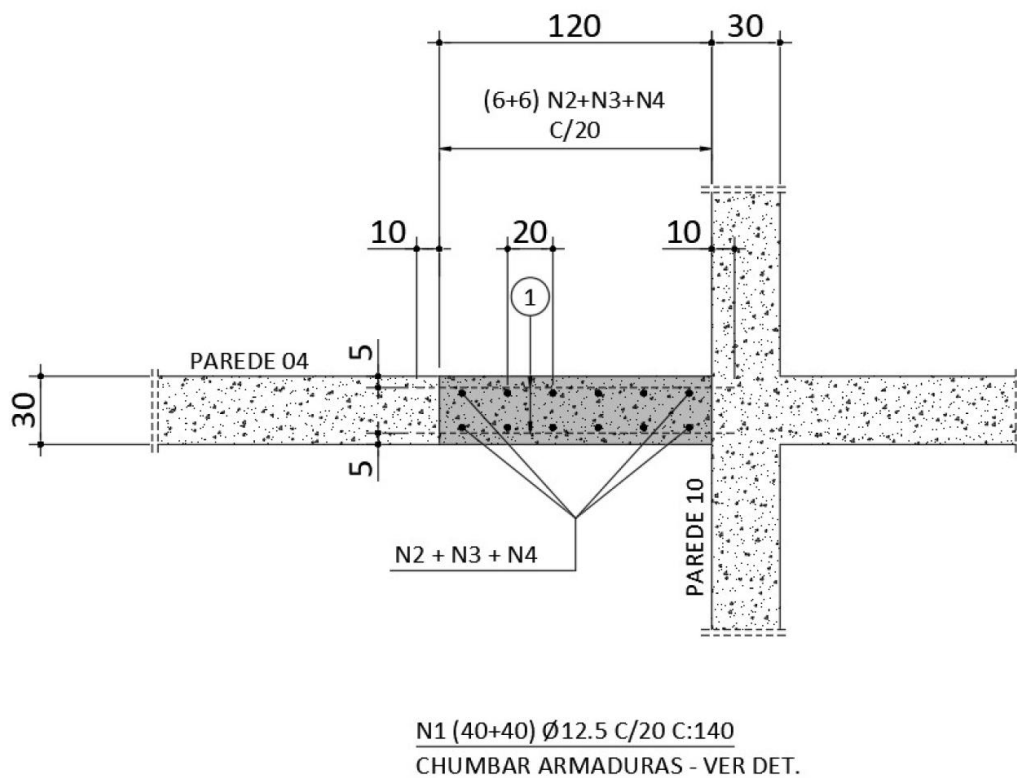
Detalhe em planta da PAR.01A – armadura longitudinal
